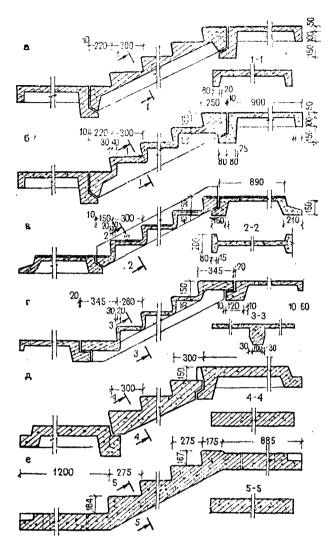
Комструктивные решения железобетонных сборных лестинц из крупных элементов
